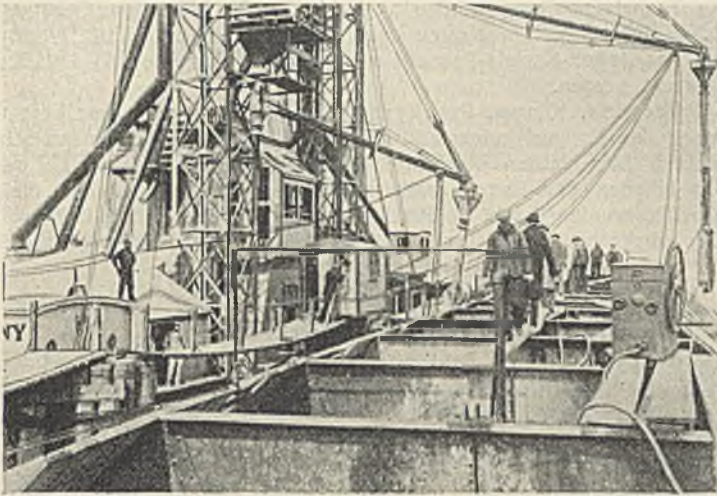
Die Betonierungsanlage im Detroit-Fluß. Zeigt die beiden Aufzüge, Behälter für den Beton, Rinnen und Schläuche.
